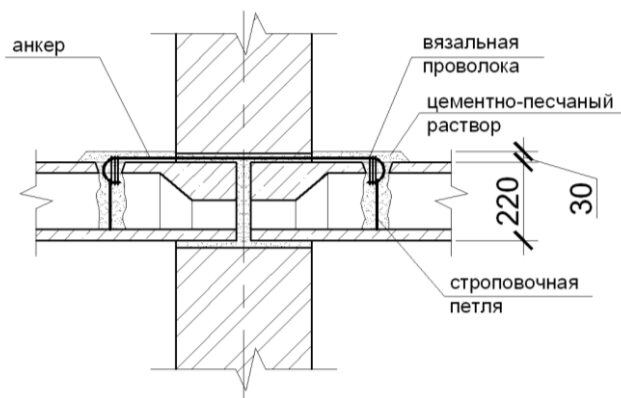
Узел опирания перекрытия на внутреннюю стену
